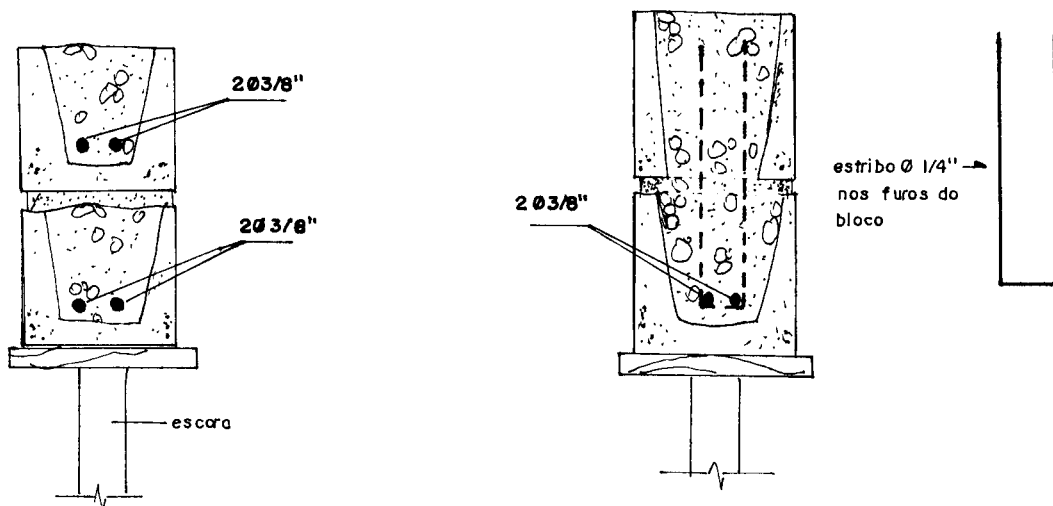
Vergas em alvenaria de bloco de concreto para vãos entre 1,50m e 2,00m
